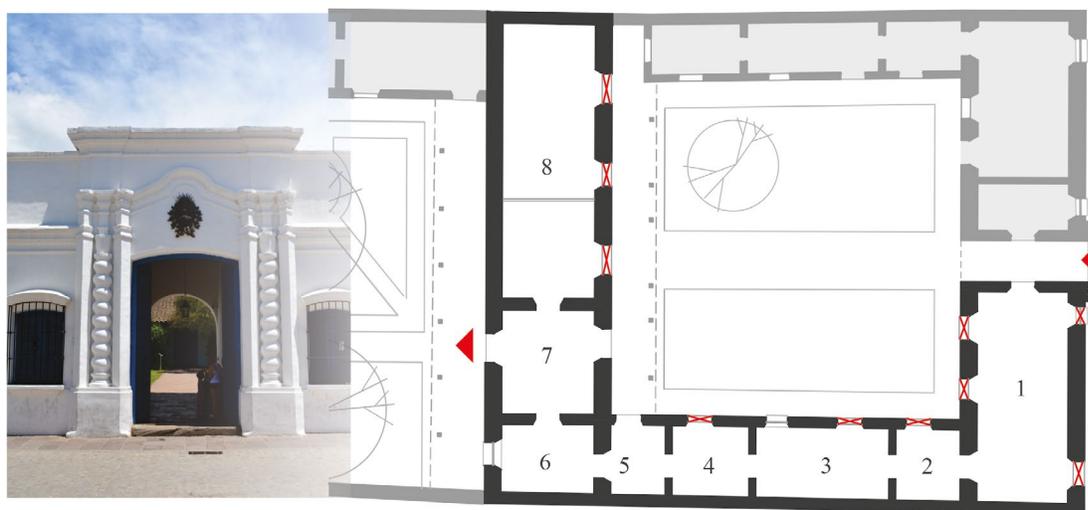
Planta y fachada del Museo Casa Histórica de la Independencia (Planimetría: Bazán y Ajmat; fotografía: Juan Ajmat, 2018).
